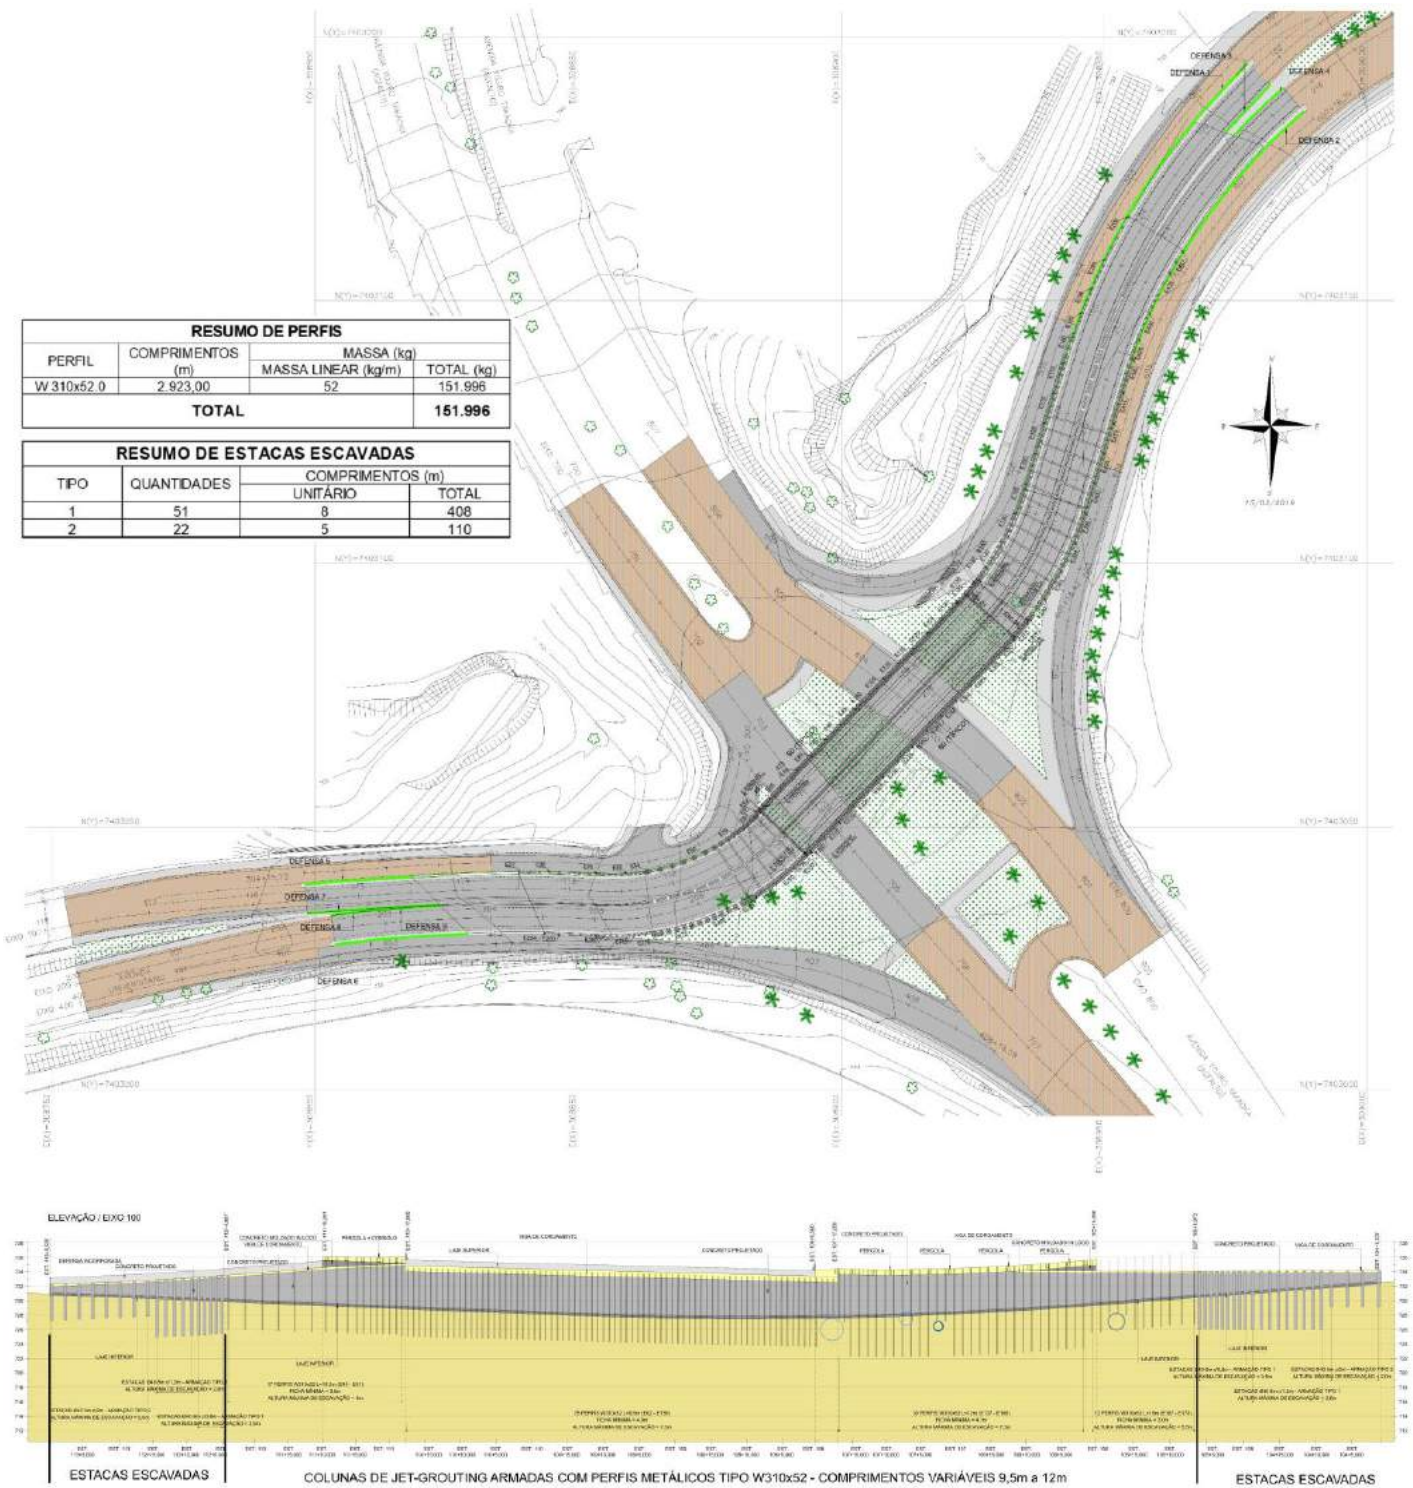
Planta e corte longitudinal do Túnel Oscar Niemeyer no projeto executado
